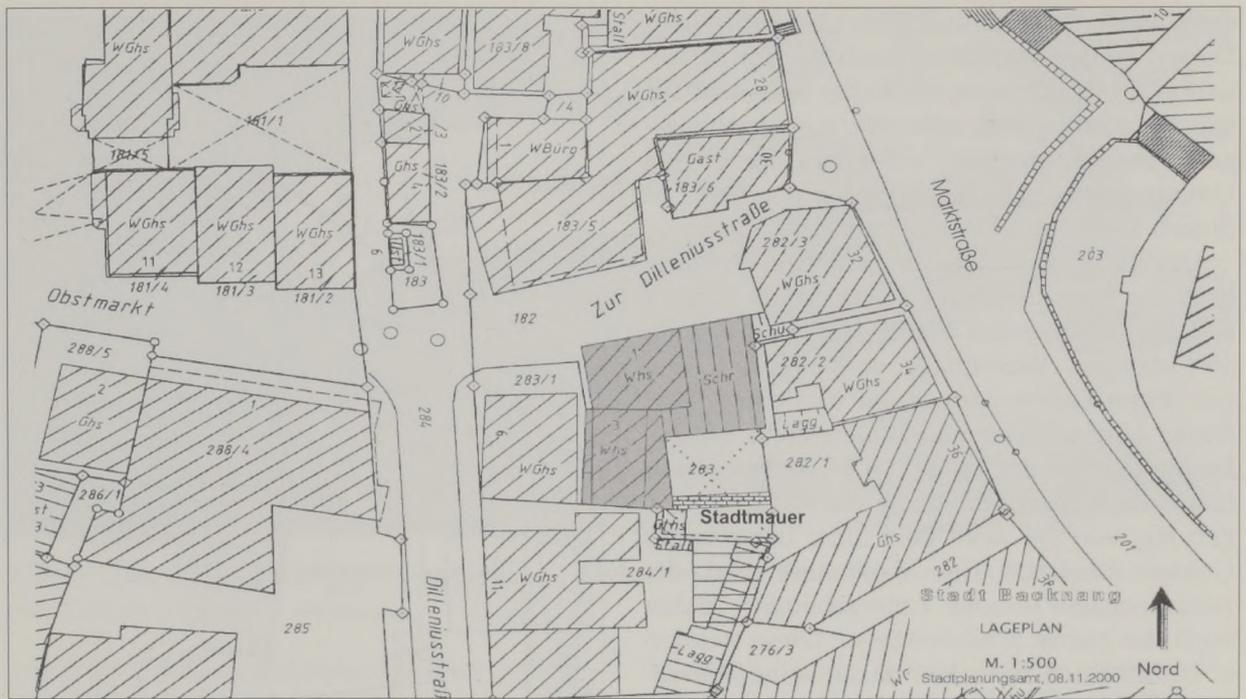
Lageplan Dilleniusstraße 1+3 von 2000 mit Stadtmauer.
